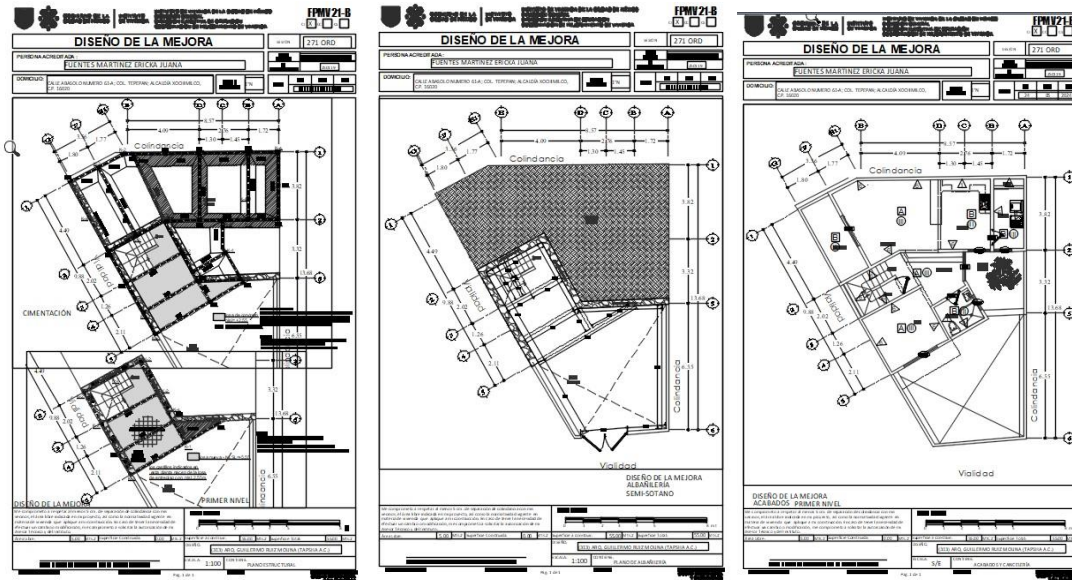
Planos ejecutivos; estructurales, albañilería y acabados.
